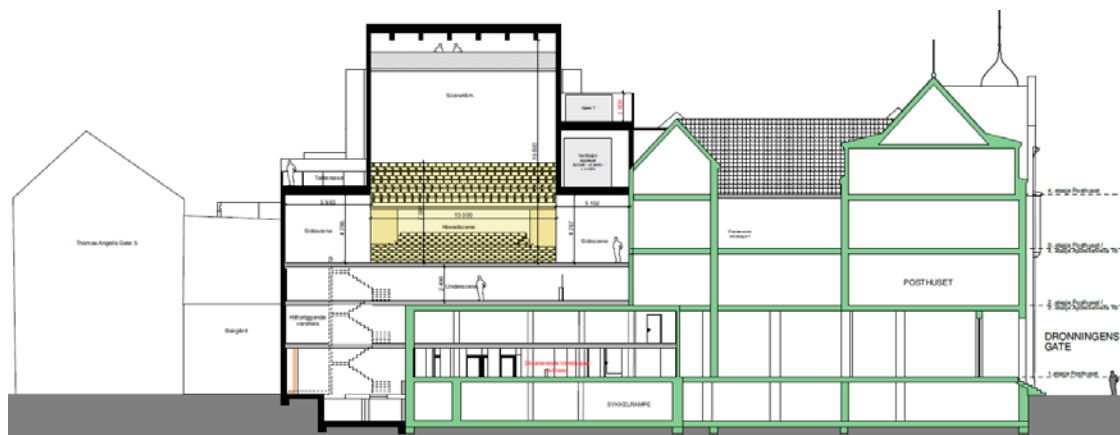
Illustrasjon av planlagt utbygging, fra arkitekt
